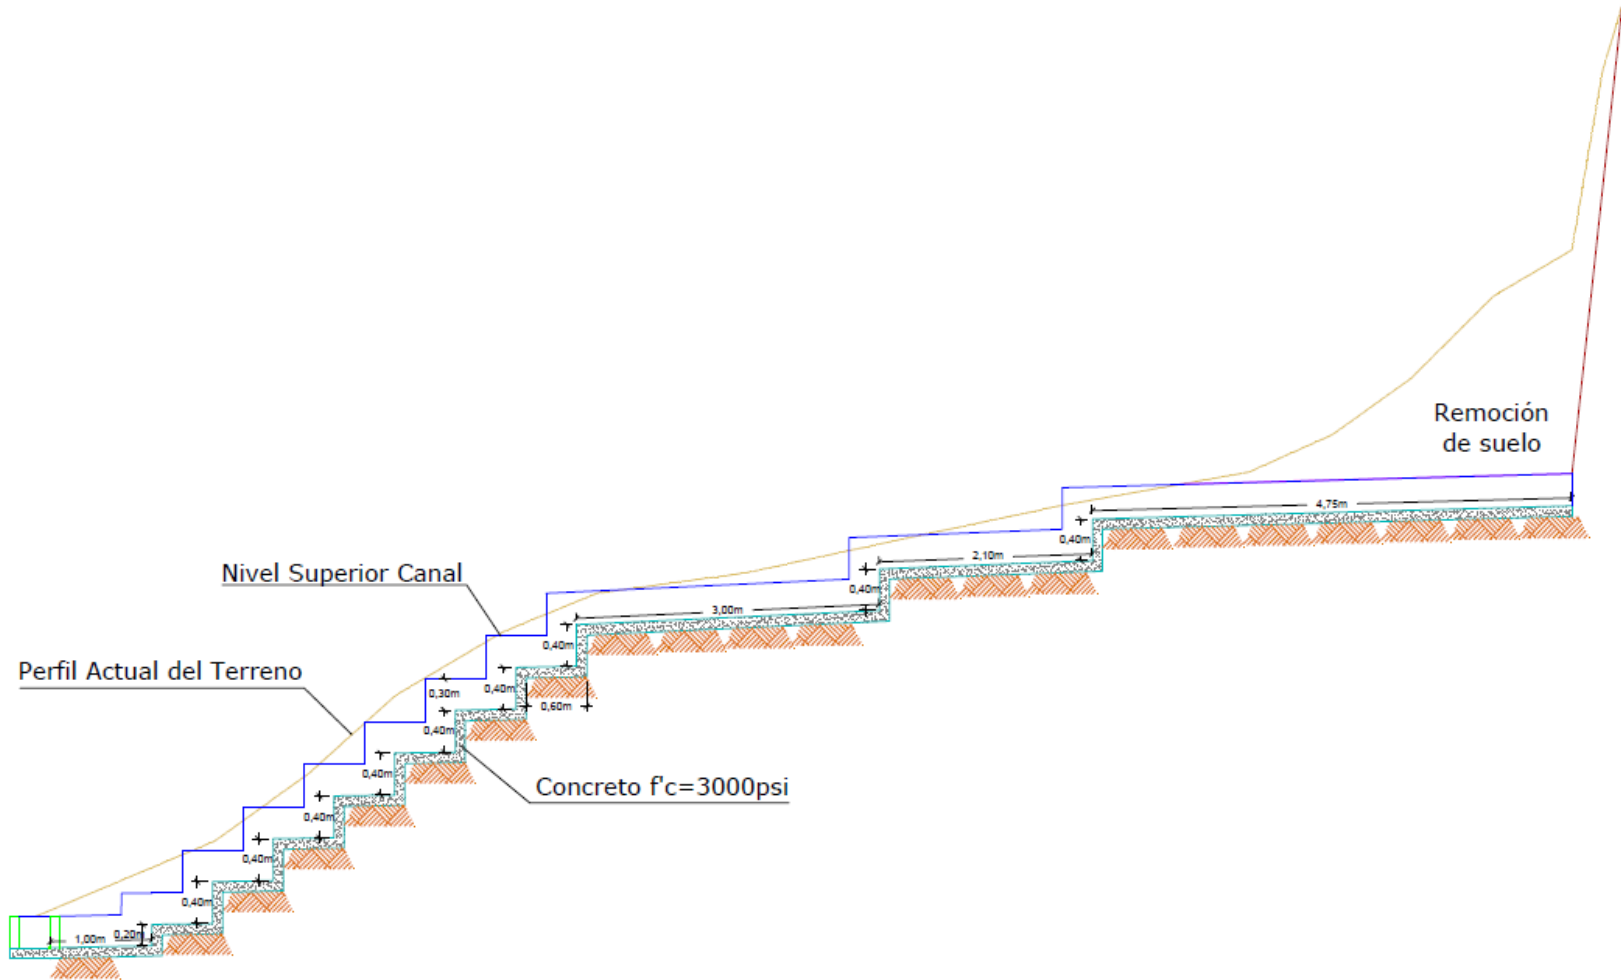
Sección canal- dissipador en concreto en el trazado de terreno.
